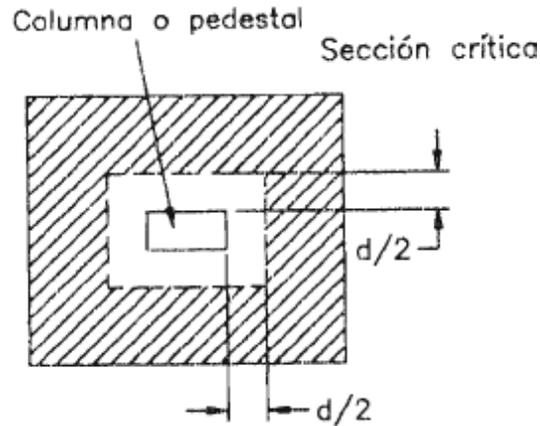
Sección crítica para el diseño del corte por punzonamiento.
